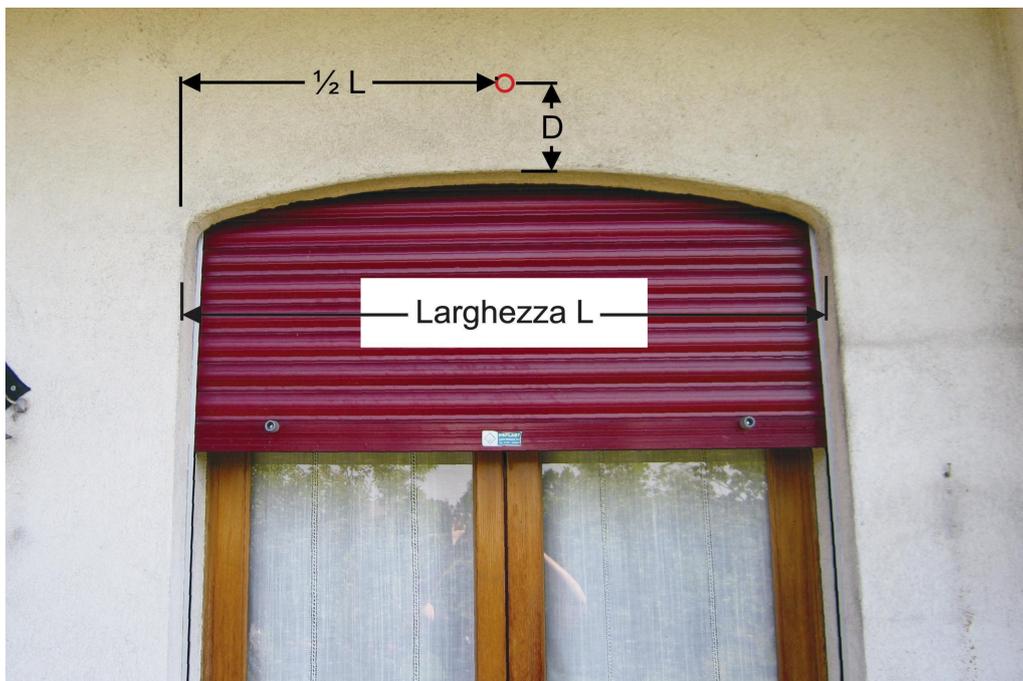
Determinazione della posizione per il foro di fissaggio centrale del profilo a muro
